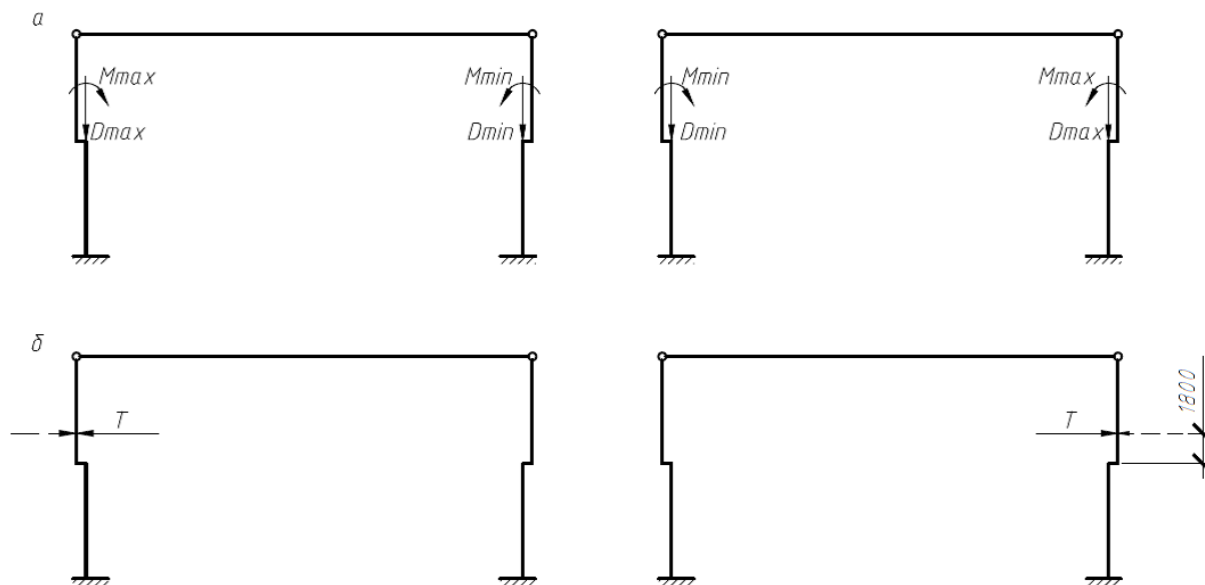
Загрузка поперечной рамы крановыми нагрузками, а – вертикальные; б – горизонтальные.
